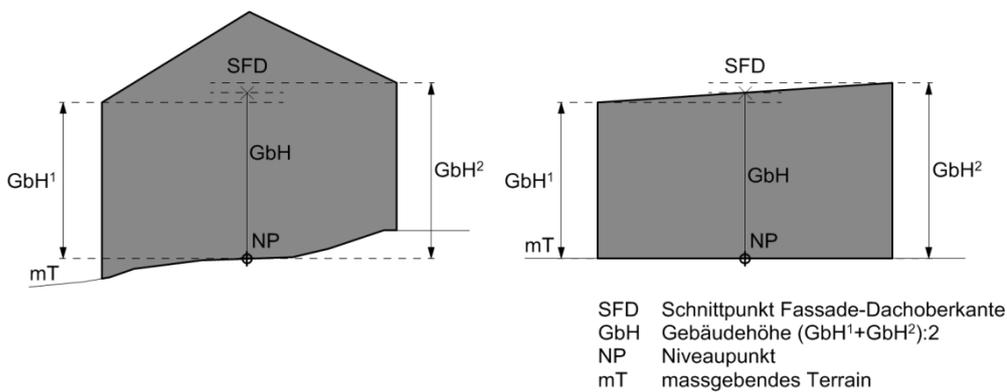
Unterschiedlich hohe Traufen: Ausgemittelter Schnittpunkt „Fassade-Dachoberkante“
